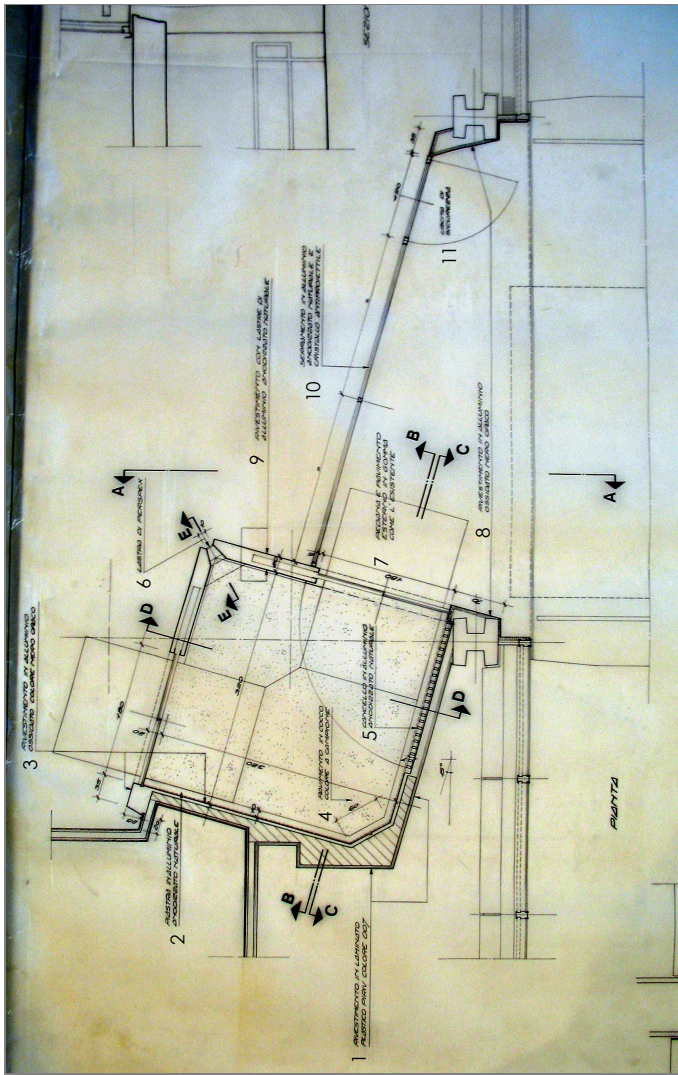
proposta di ristrutturazione generale – nuova sistemazione bussola ingresso piano primo – pianta (fonte CSAC , stralcio tav. 71, archivio n. 371-1, rielaborazione f.m.)
